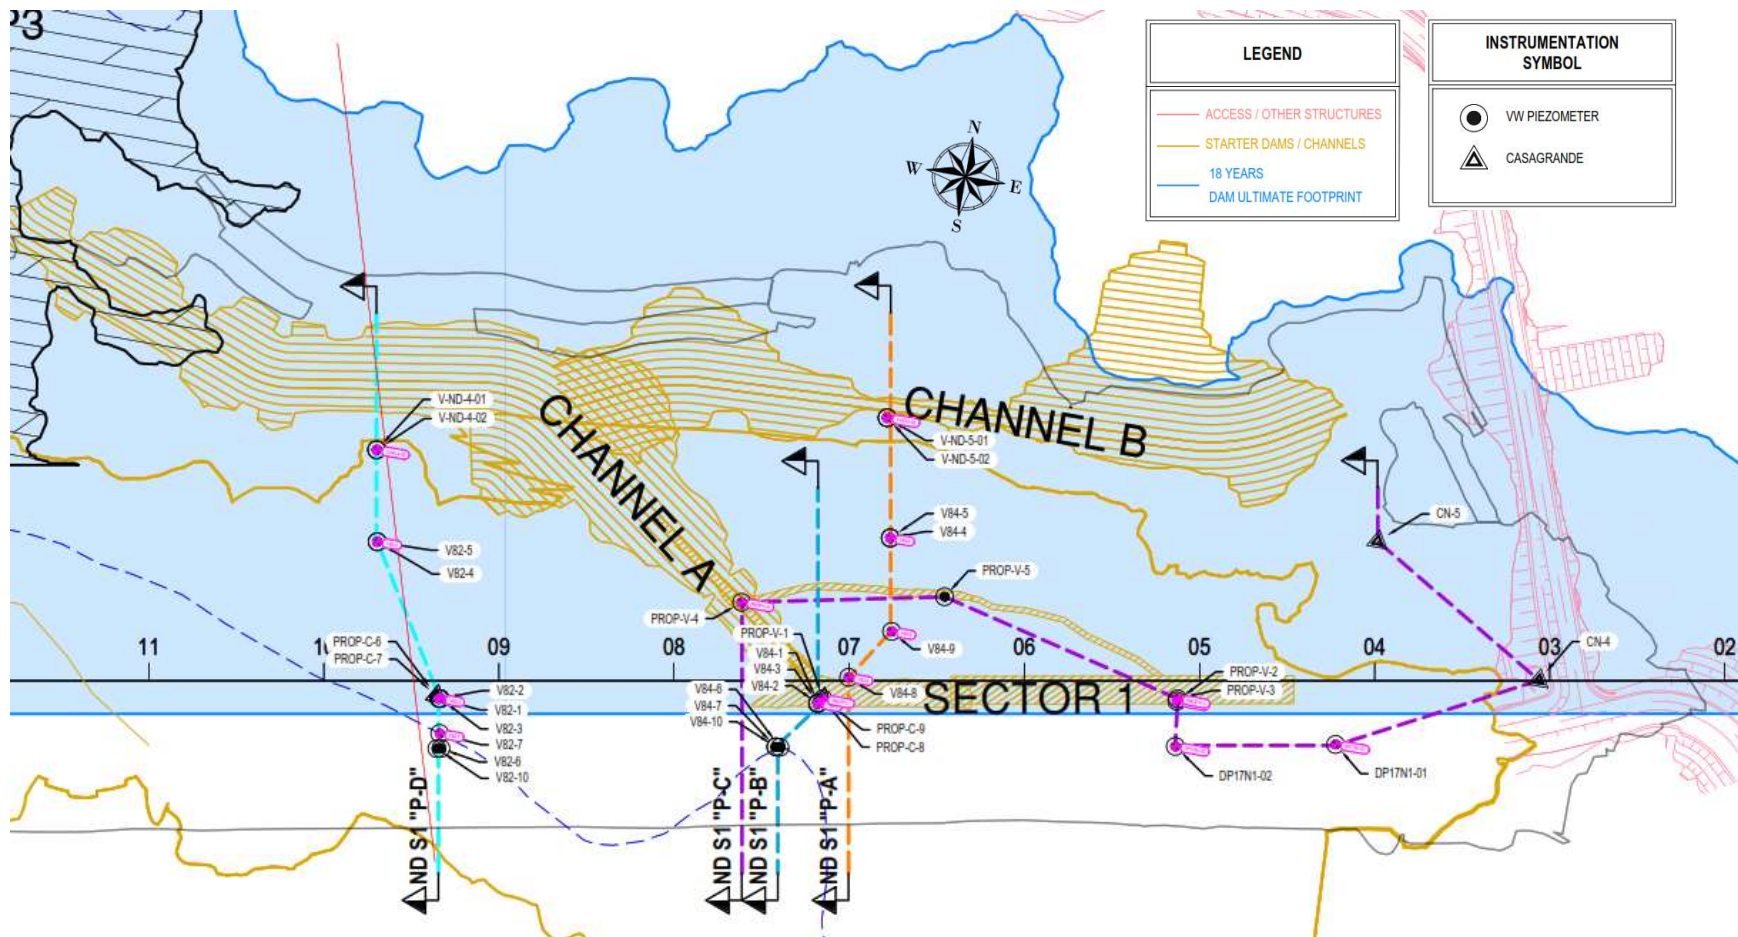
1: Vista en planta de ND Sector 1 - Grupos de instrumentos Piezómetro y Casagrande
